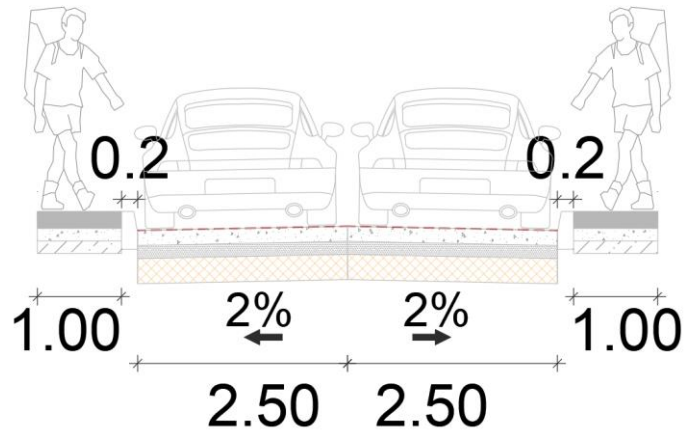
Sección transversal - Calle Juego de la Pallca y Calle Juego de Ajedrez
